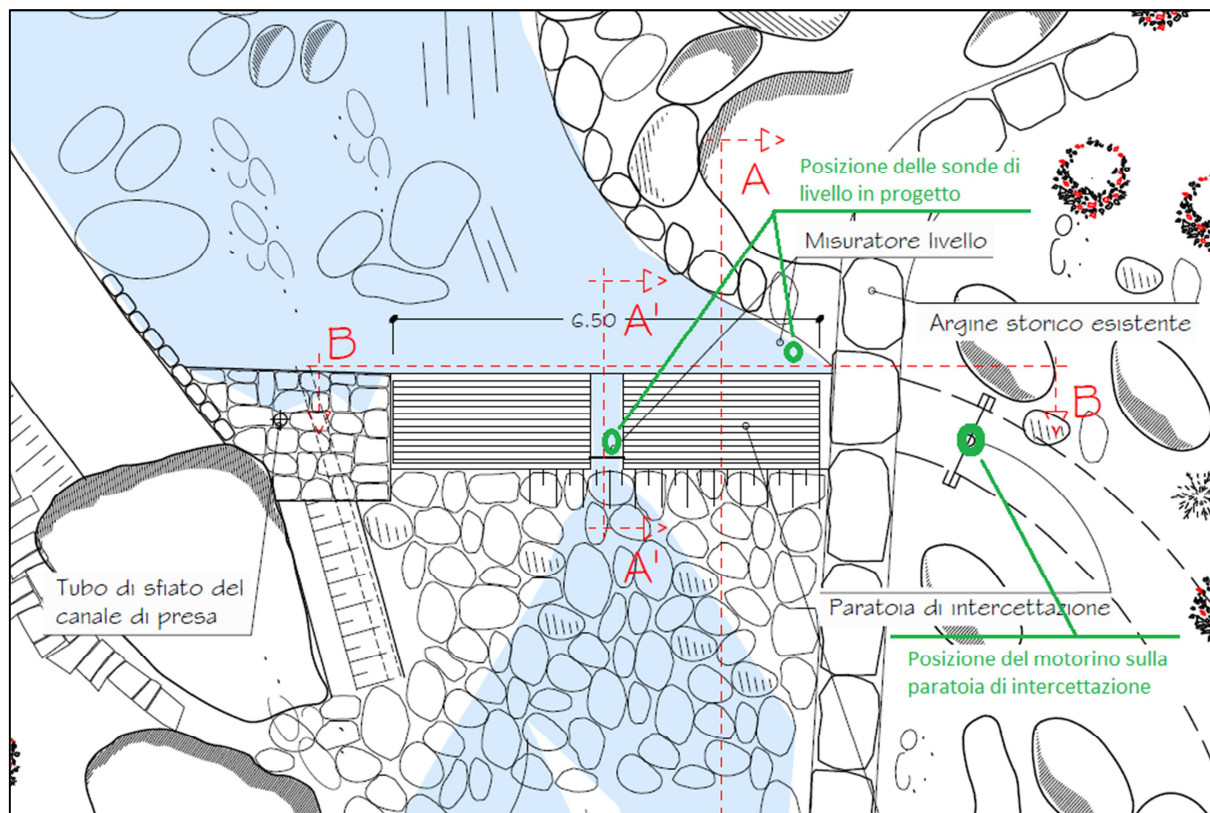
Estratto pianta opera di presa principale con posizione interventi previsti
